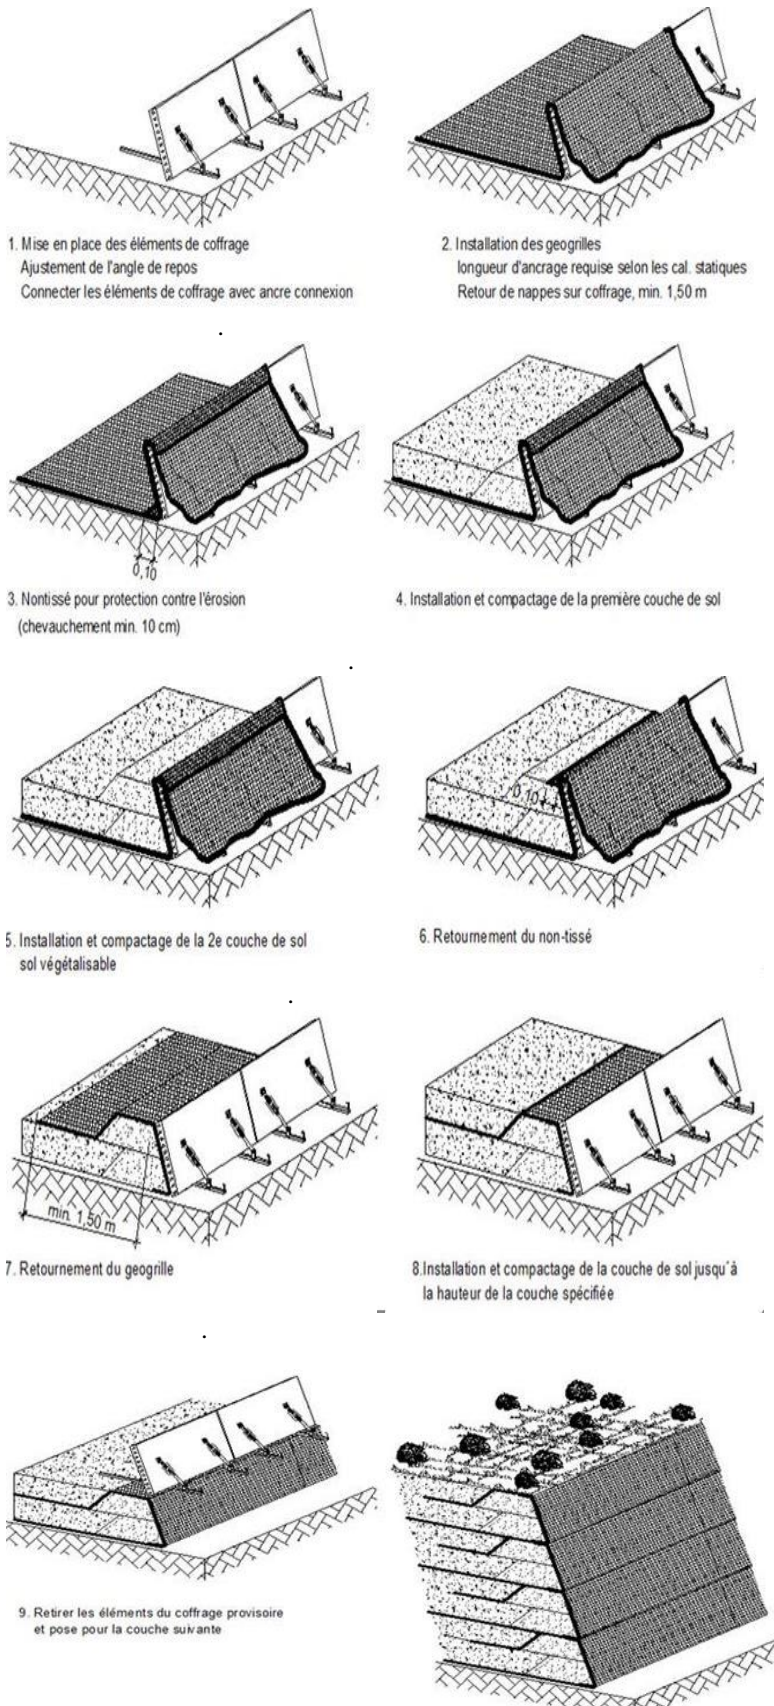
Procédé général de construction d'un ouvrage de soutènement en sol renforcé par géogrilles
